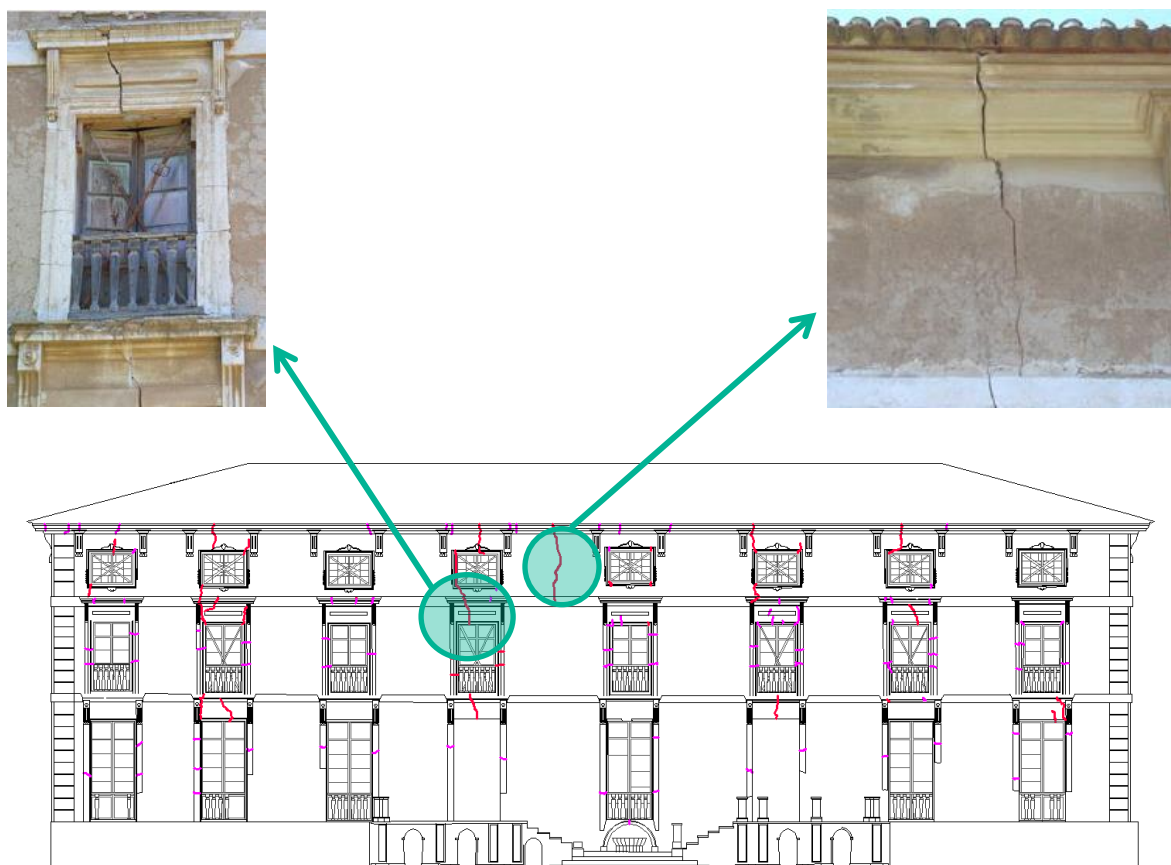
Alzado jardín principal. Ejemplo grietas. Fuente: Elaboración propia
